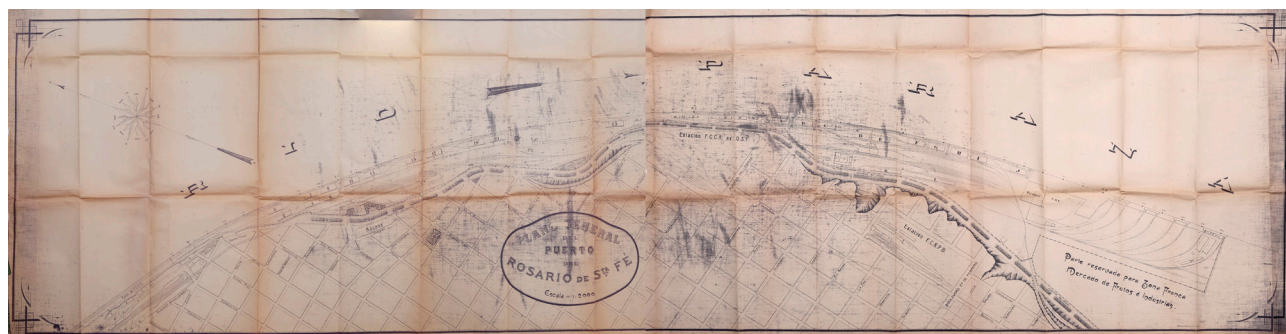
| Plano General del Puerto del Rosario de Santa Fe (diciembre 1916). Fuente: Archivo ENAPRO.
